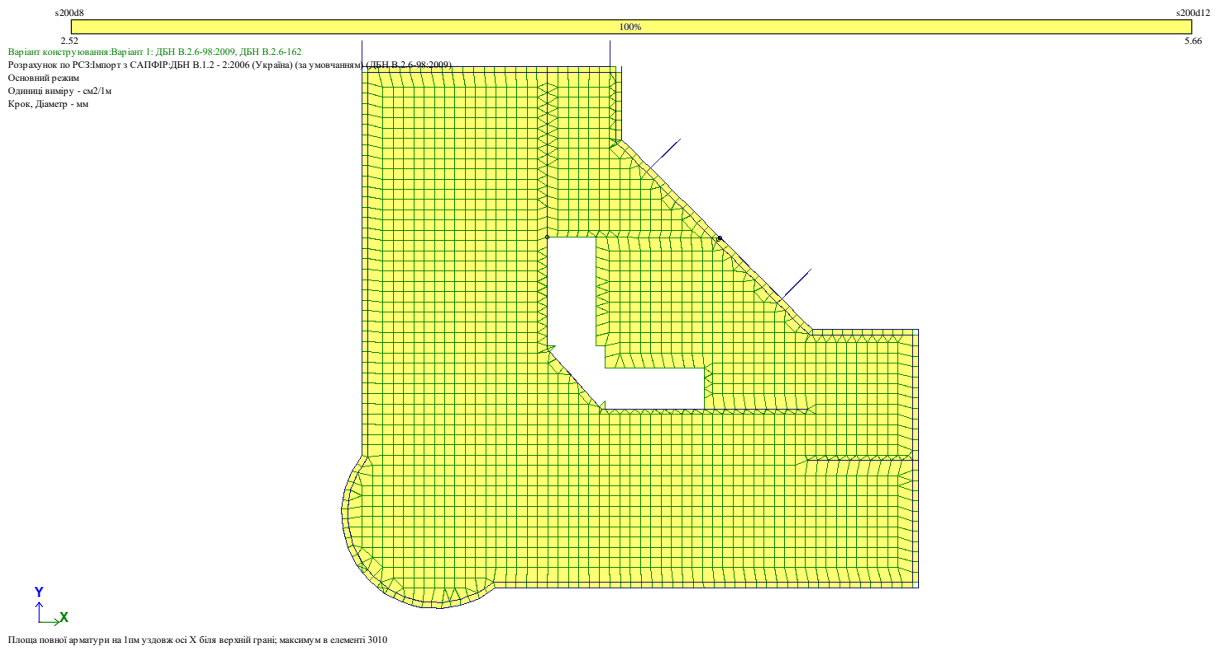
Площа повної арматури на 1м уздовж осі X біля верхній грані для плити перекриття цокольного поверху
